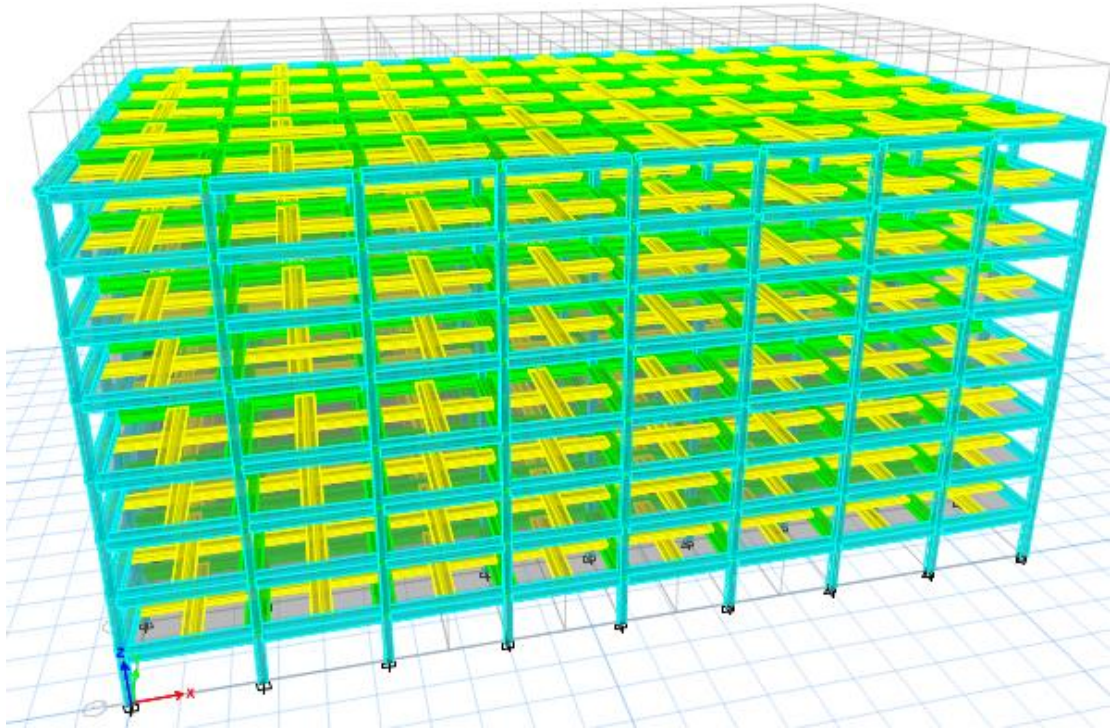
Denah Model 1 Lantai 1 – Lantai 7 tanpa *Seaworld
